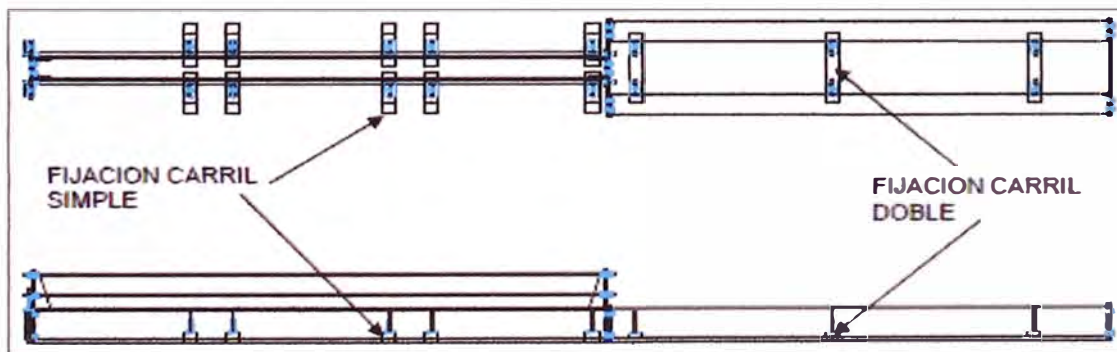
Vista planta y elevación de fijación de carriles de avance.
